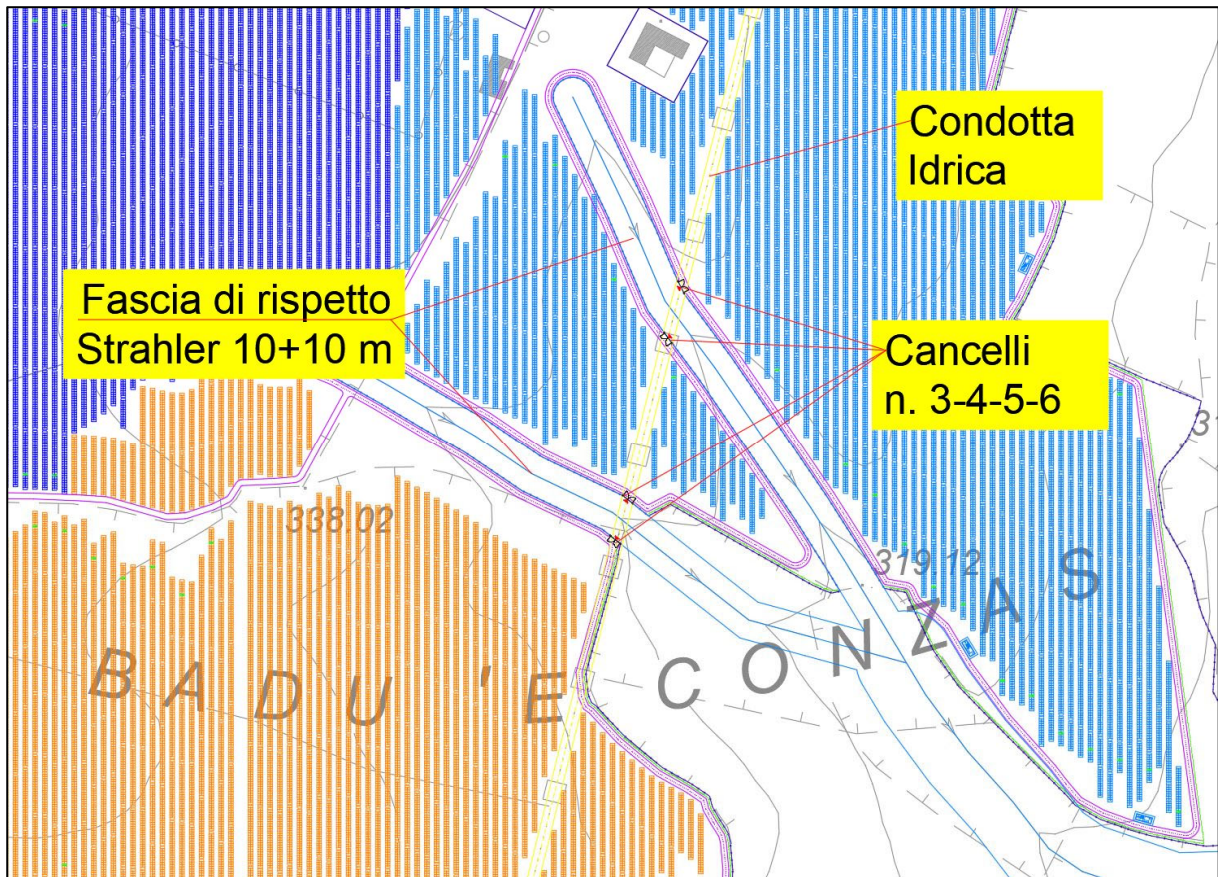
Stralcio area d’impianto con individuazione accessi su fasce di rispetto
